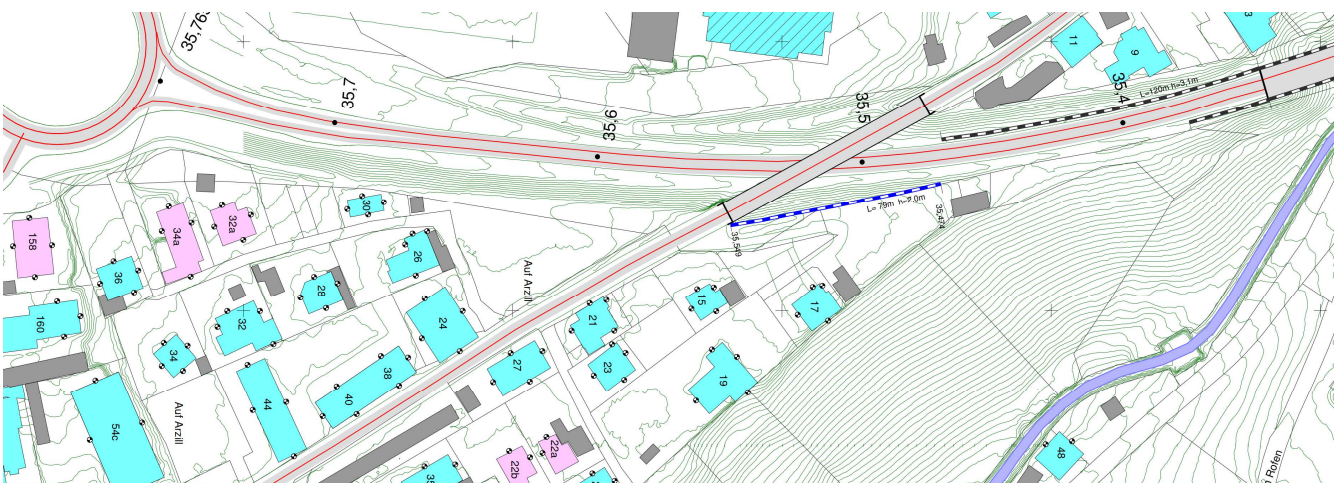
Übersichtslageplan mit baul. Schallschutz V03, Auszug aus Plan H016_32 /6/
